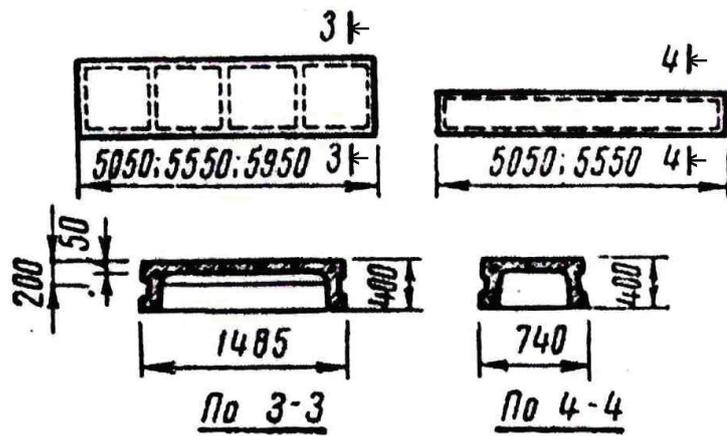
Сборные железобетонные плиты перекрытия многоэтажных промышленных зданий
